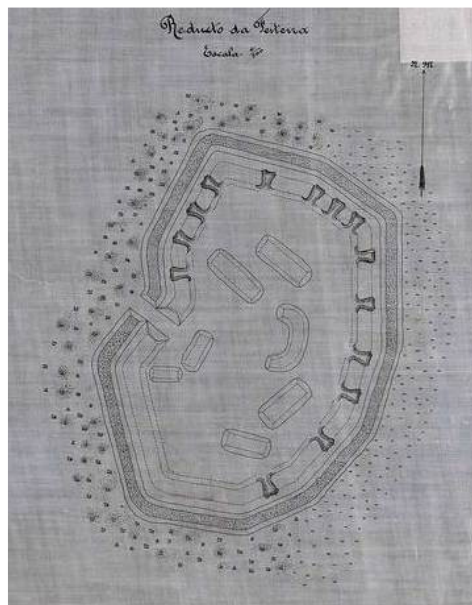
Planta do Forte da Feiteira (Reduto n.º 129)
